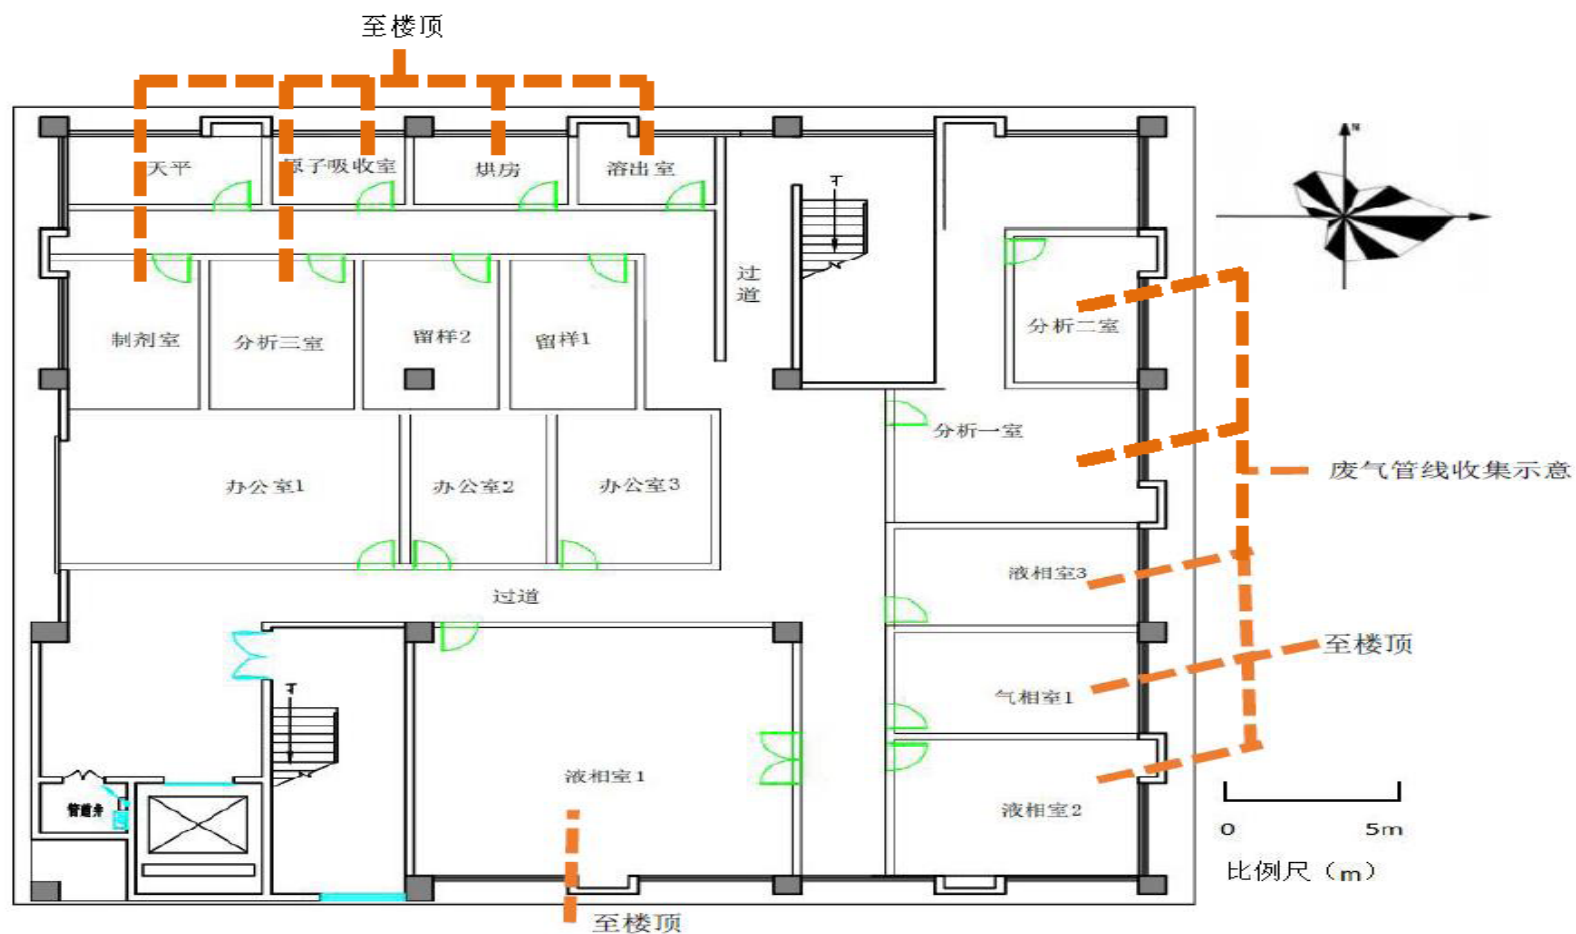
(3) 实验综合楼 3 层总平面布置图
